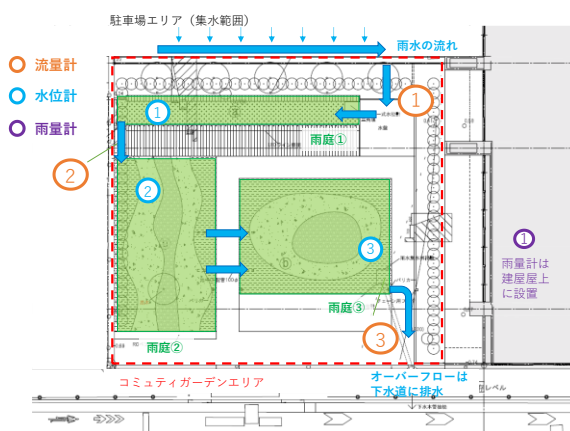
東陽町ぐりんとすの雨庭の平面図と計測機器配置
